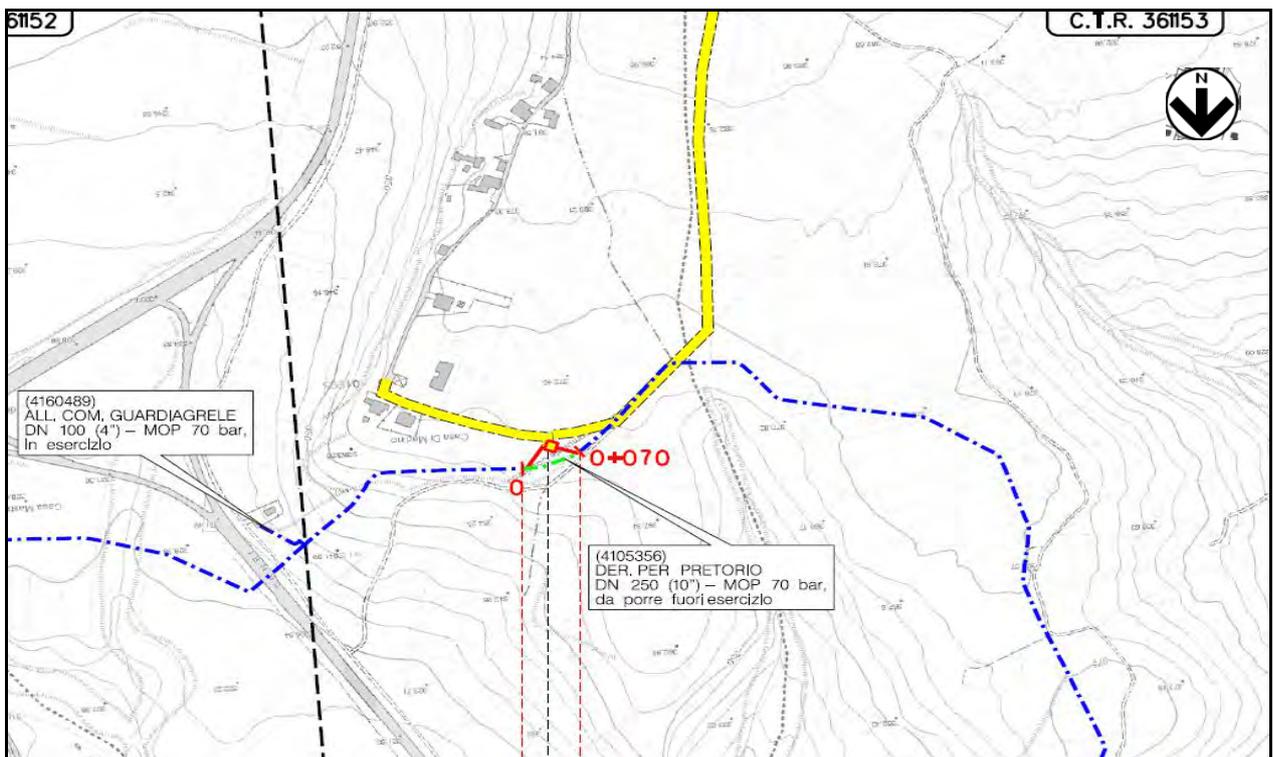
/E.b – Planimetria 1:5.000 con localizzazione dell'area dell'Intervento n.4 (progetto in rosso, dismissione in verde, esistente in blu)
